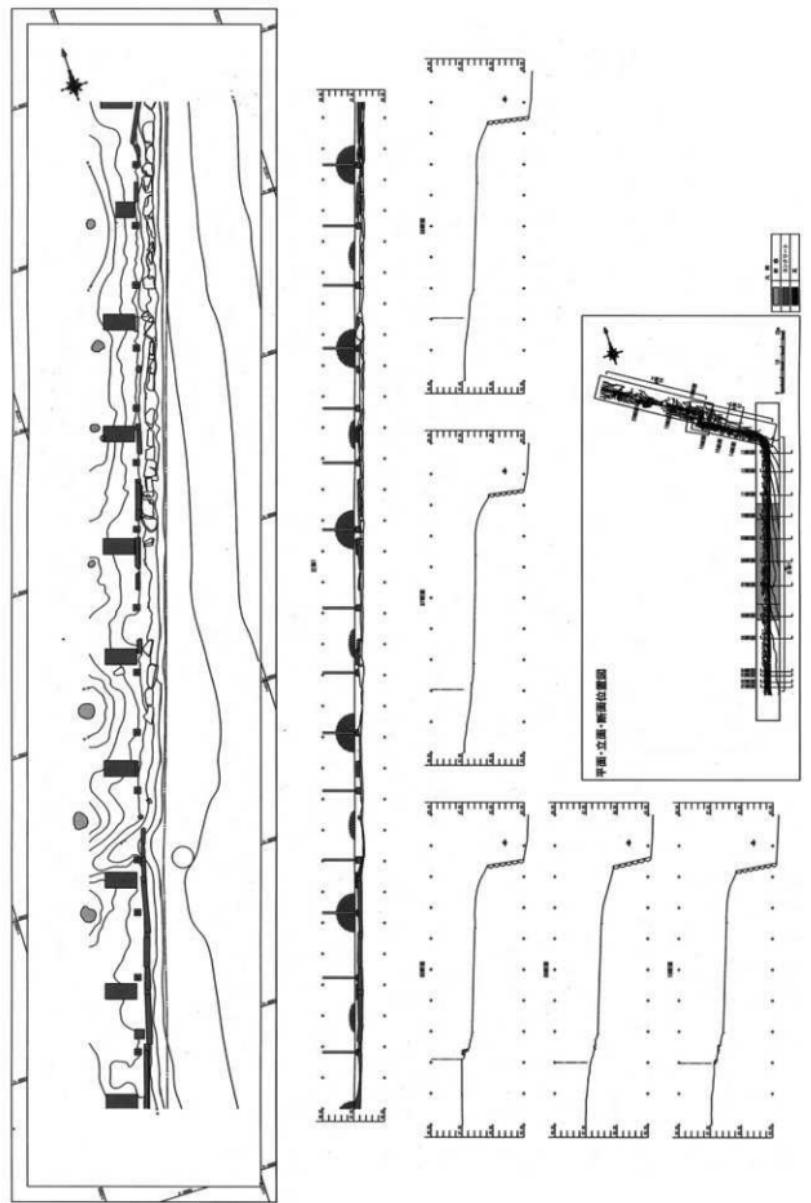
H25瀬戸弘道館橋測量調査 平面図・立面図・断面図2
